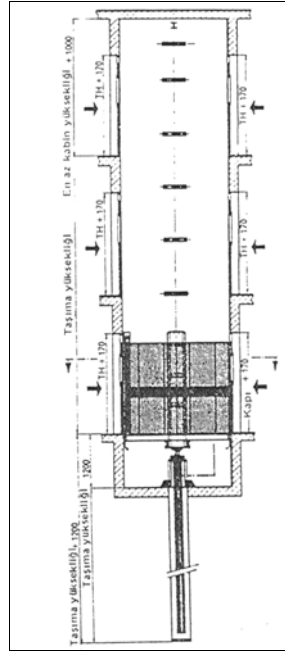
Panoramik Asansör Plan Örnekleri
